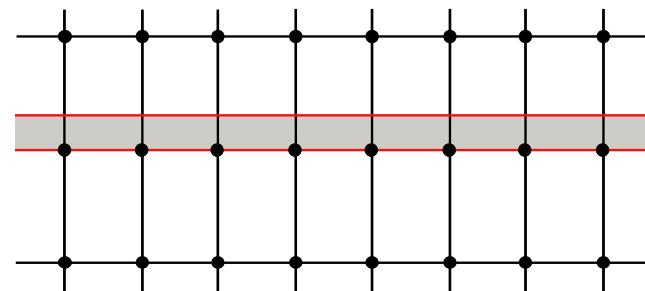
Systemgrundriss, Mittelflur und ungleiche Raumtiefen
